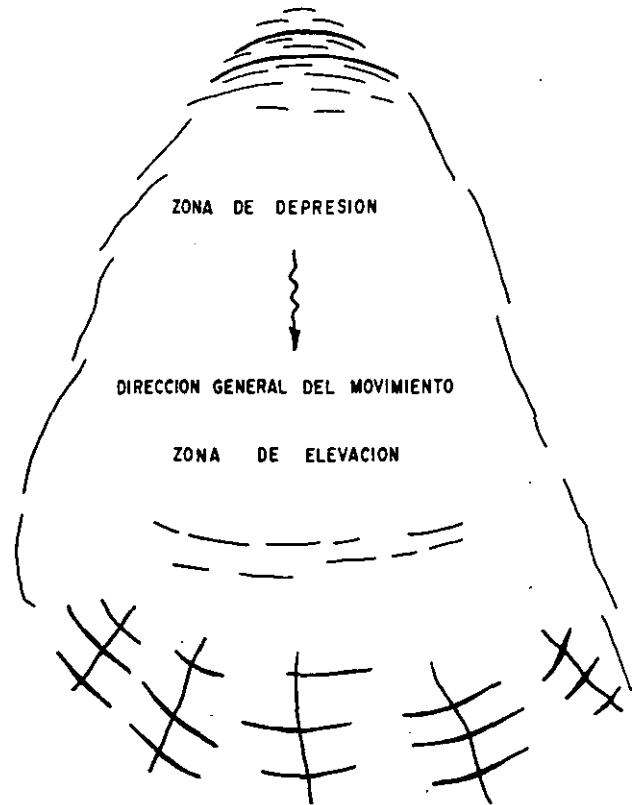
Planta típica de agrietamiento en un deslizamiento de tierra (Ref. 8).
